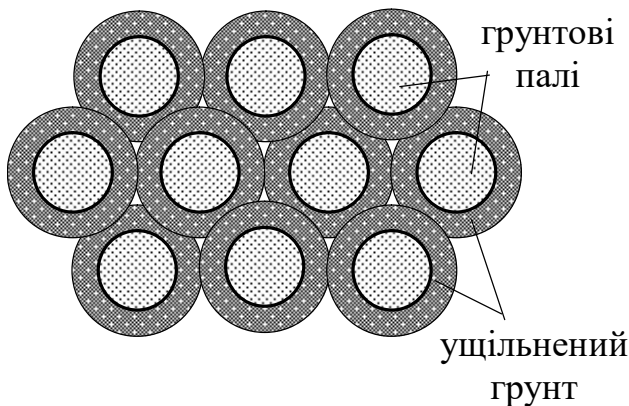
Схема ущільнення основи ґрунтовими палями
